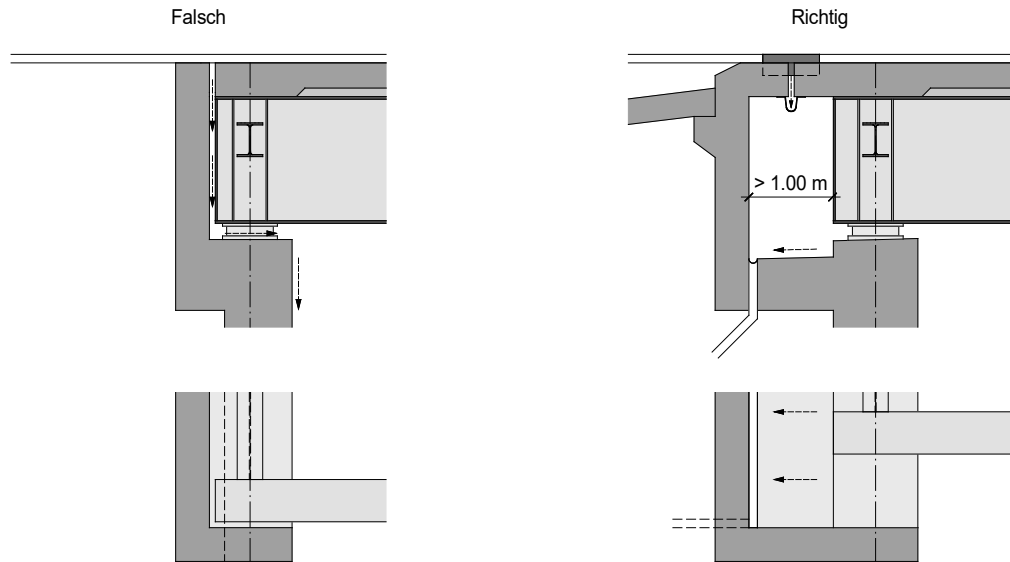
Ausbildung der Widerlagerkonstruktion (Ansicht und Grundriss).
